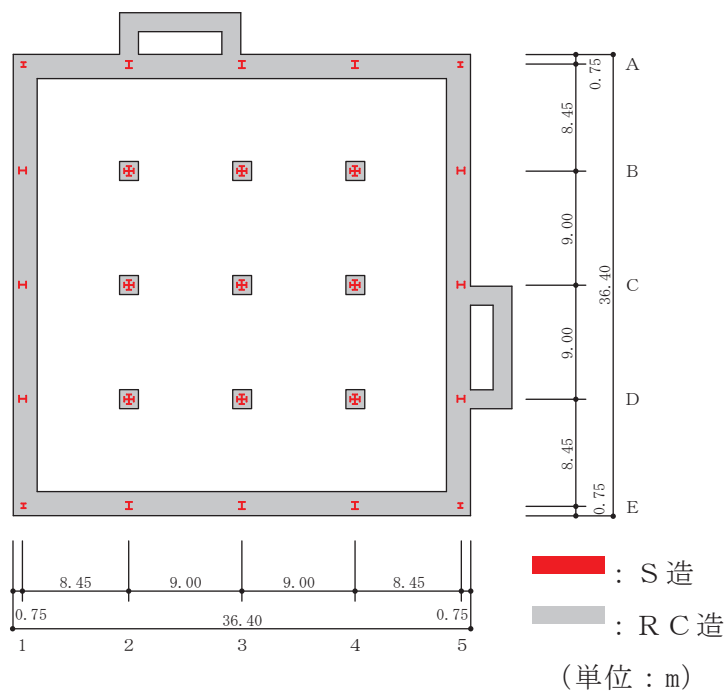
(2) 緊急時対策建屋の概略平面図 (O.P. 57.3m)
